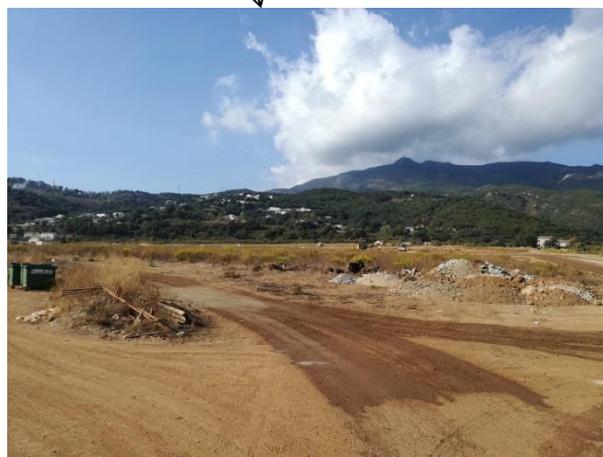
APERÇU DES TRAVAUX ENTREE NORD
